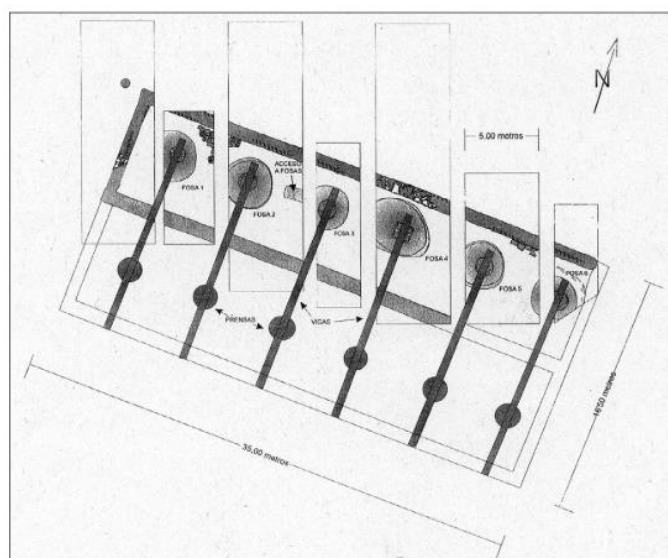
Planta y reconstrucción de la almazara. Fase I (SERRANO, 2004: 165).
